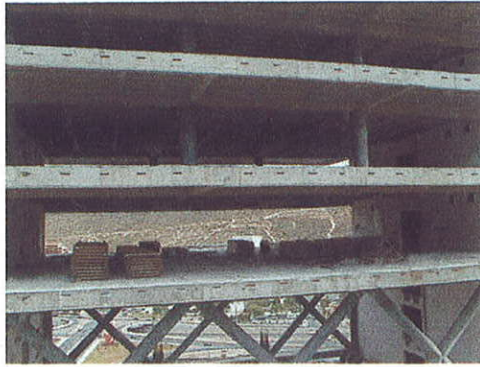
Una planta con excepcional diaphanidad. En el espacio comprendido entre los núcleos de hormigón no existe un solo elemento estructural vertical (Tirante o pilar).
